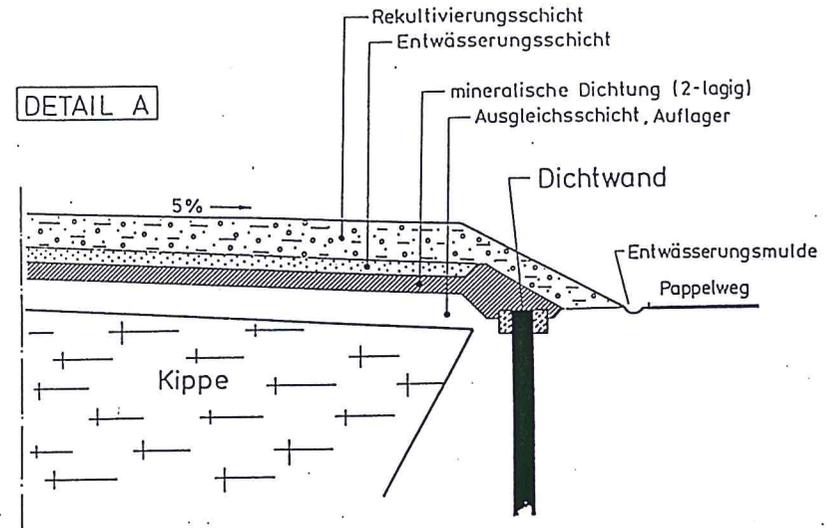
Anschluß an die Oberflächenabdichtung an die Dichtwand (Straßenbereich)
